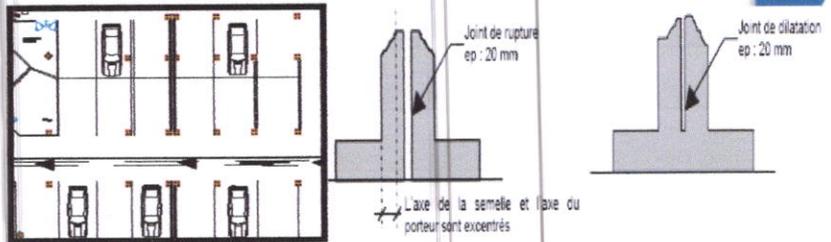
Joint de dilatation entre bâtiment et bâtiment (plan sous-sol)/source :Google image et plans sous-sol parking
